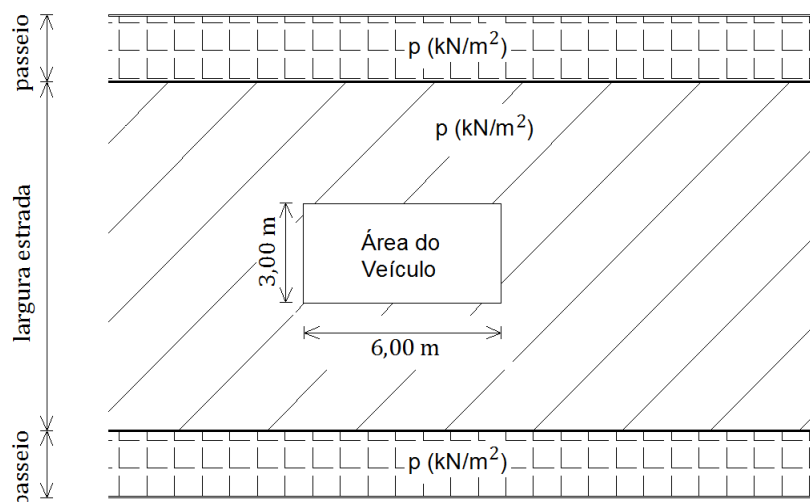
Configuração em planta das sobrecargas na estrada e nos passeios (ABNT)
